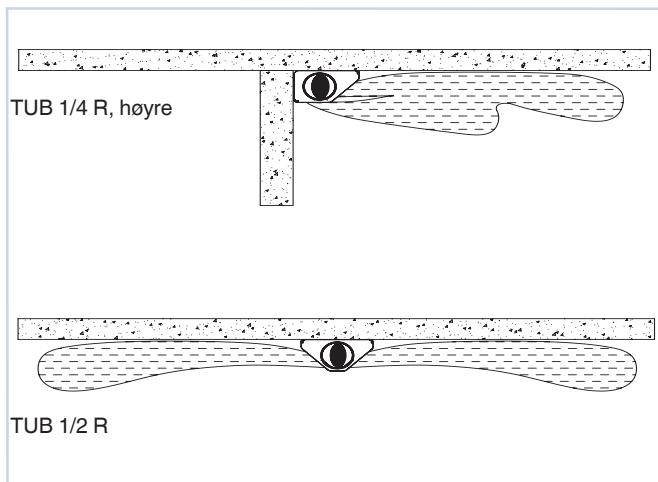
, TUB 1/2 R, spredningsmønstre i plan.
